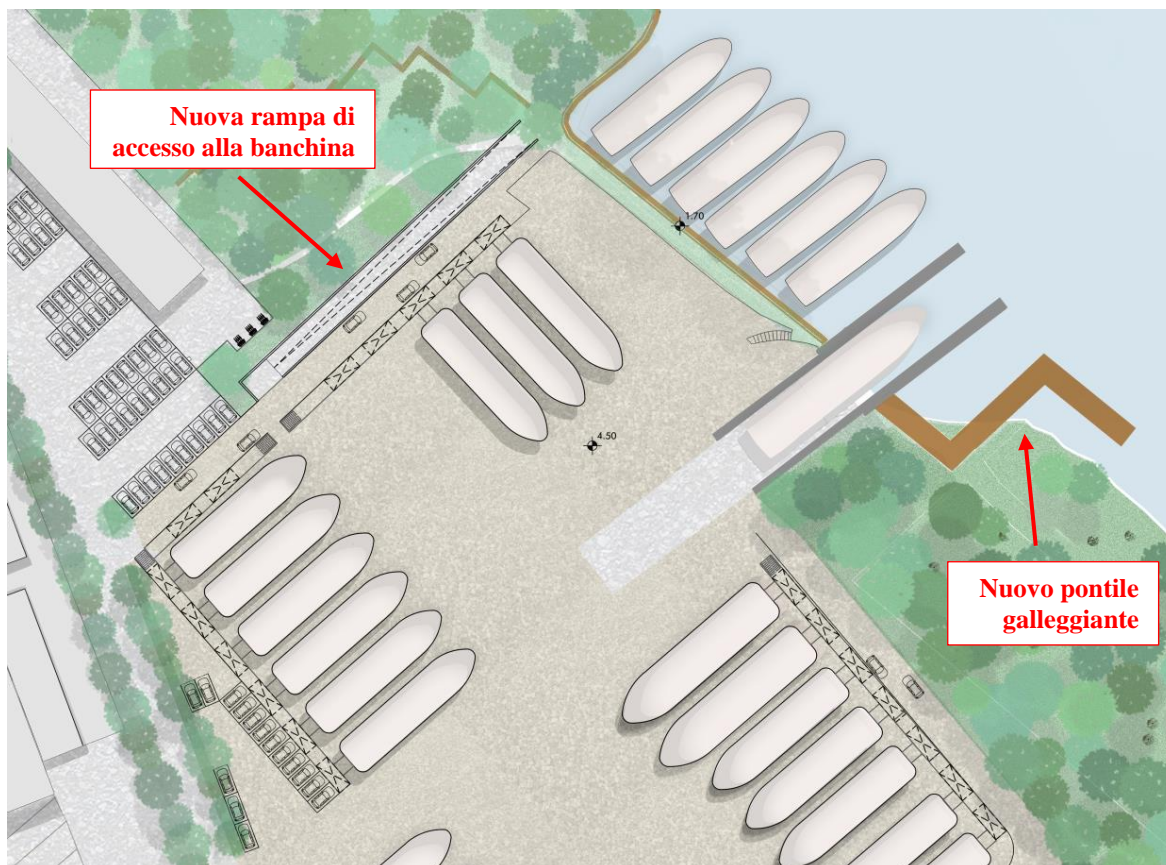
stato di progetto area refitting attuale (Marina Travel)
